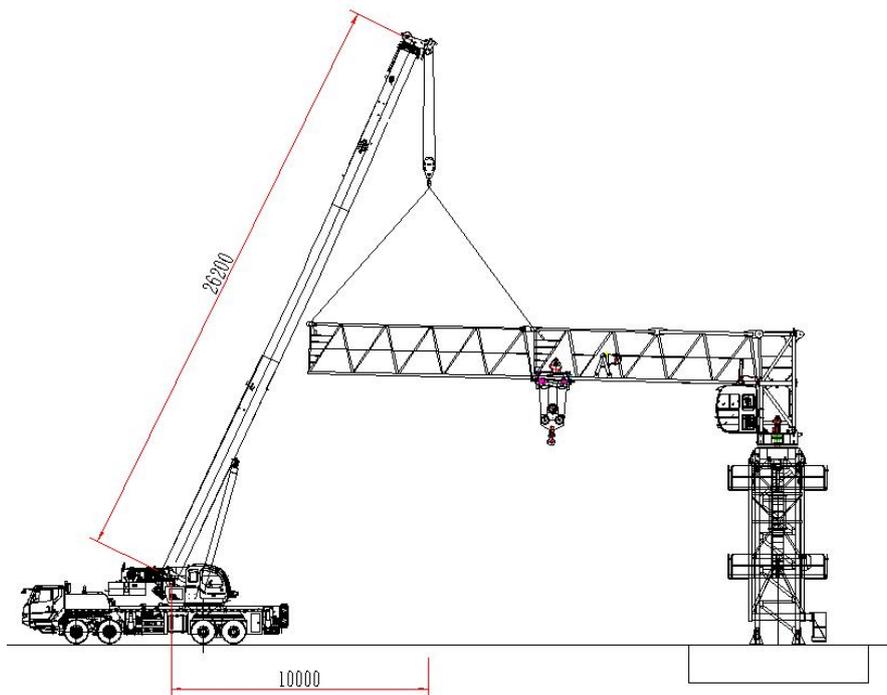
起重臂臂节二拆除立面图 (单位: mm)
